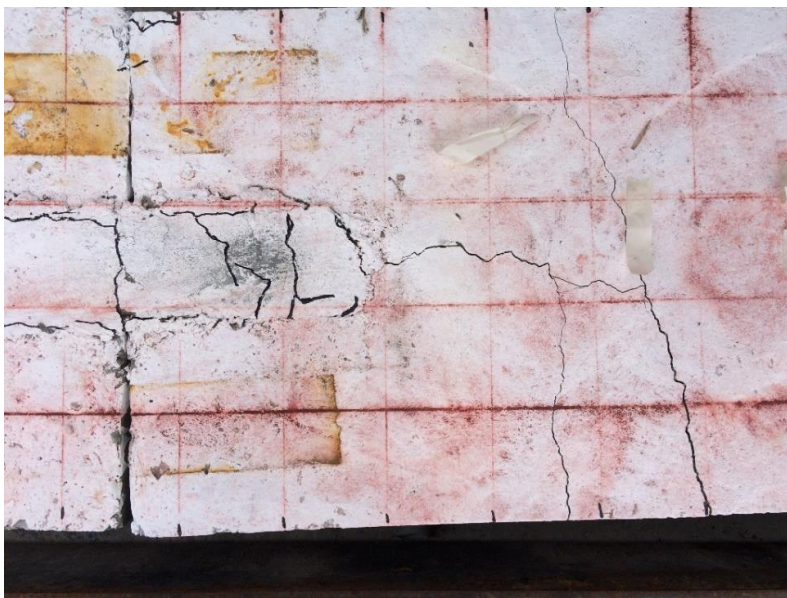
Falla por flexión de pieza de concreto de 2.20m de longitud.
